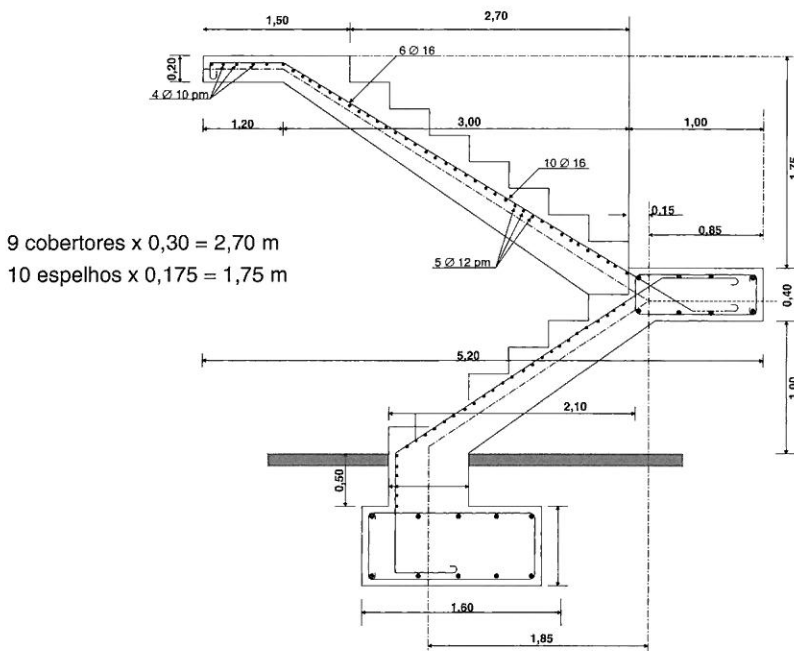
Disposição das armaduras da escada do exemplo 2.2
